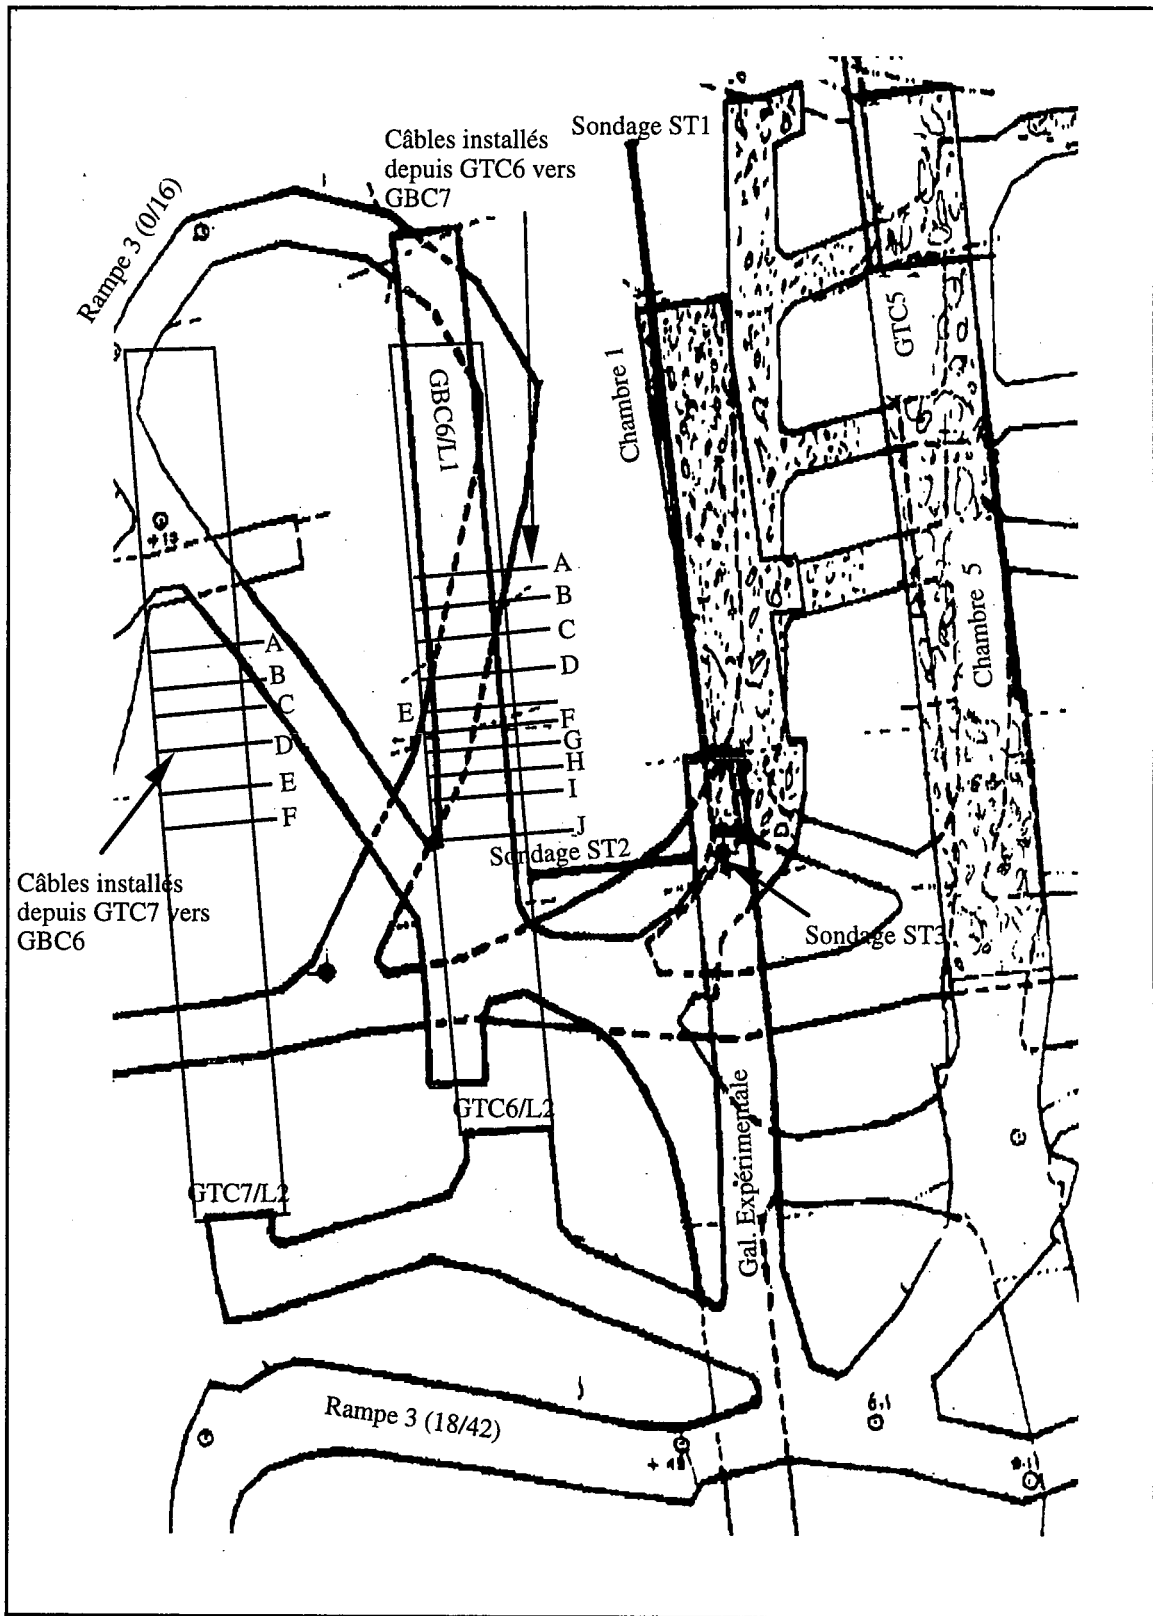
Plan des galeries GTC7 et GTC6 montrant la position des sections de câbles d'ancrage
